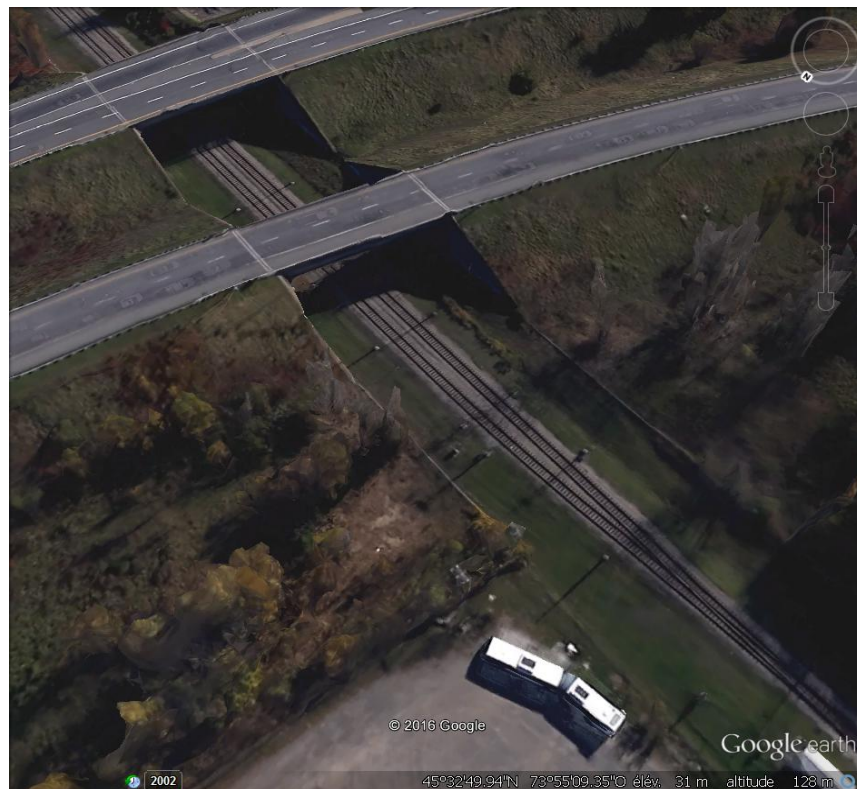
Exemple d'étagement supérieur de la route au-dessus d'une voie ferrée
